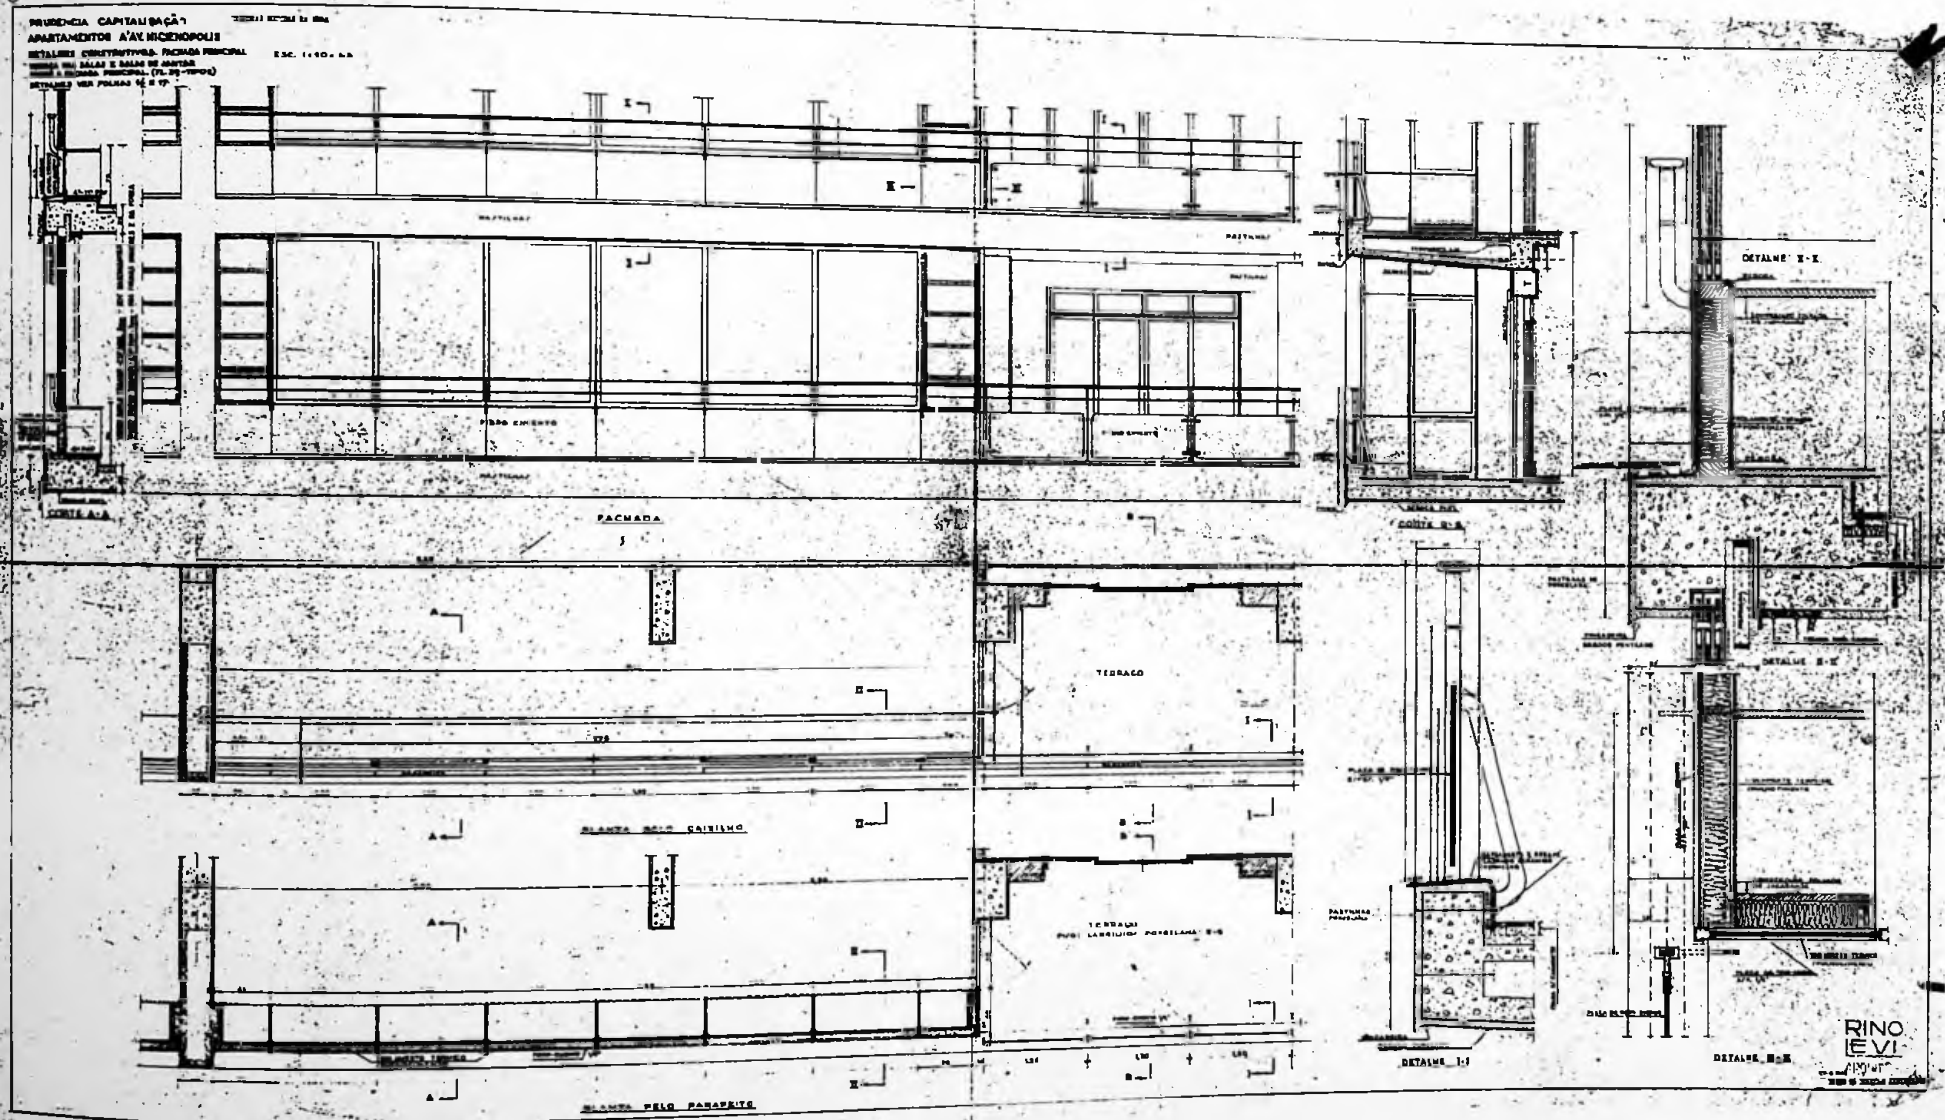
detalhes construtivos / vidraças nas salas e sala de jantar sobre a fachada principal
